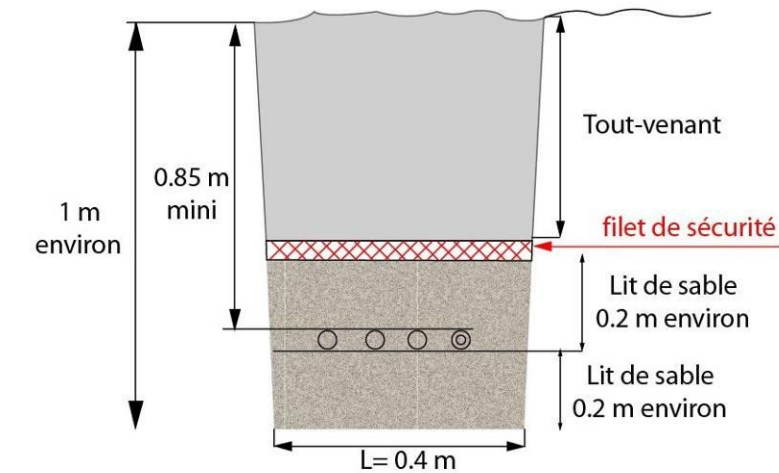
Coupe de tranchée pour enfouissement de ligne
